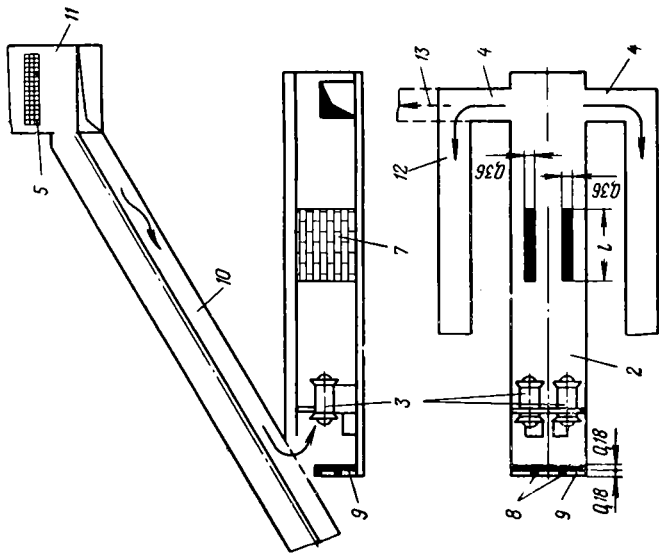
Схема размещения пластинчатых глушителей шума из бетонных шумопоглощающих блоков в вентиляционной установке тоннельной вентиляции, расположенной на станции метрополитена глубокого заложения между путевыми тоннелями под наклонным эскалаторным тоннелем:
